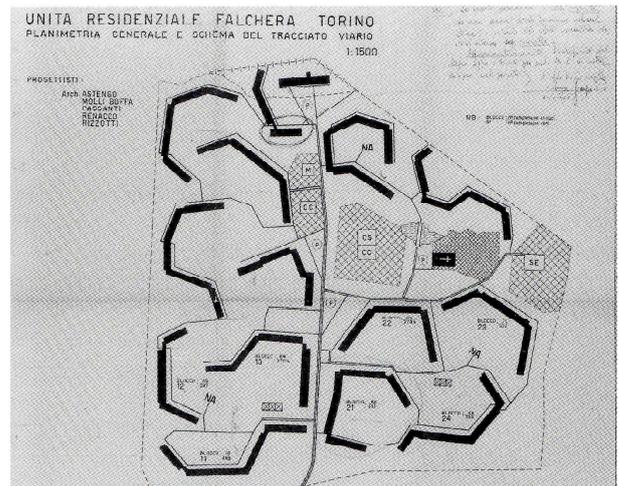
Planimetria Generale della versione successiva al primo progetto, 1951
